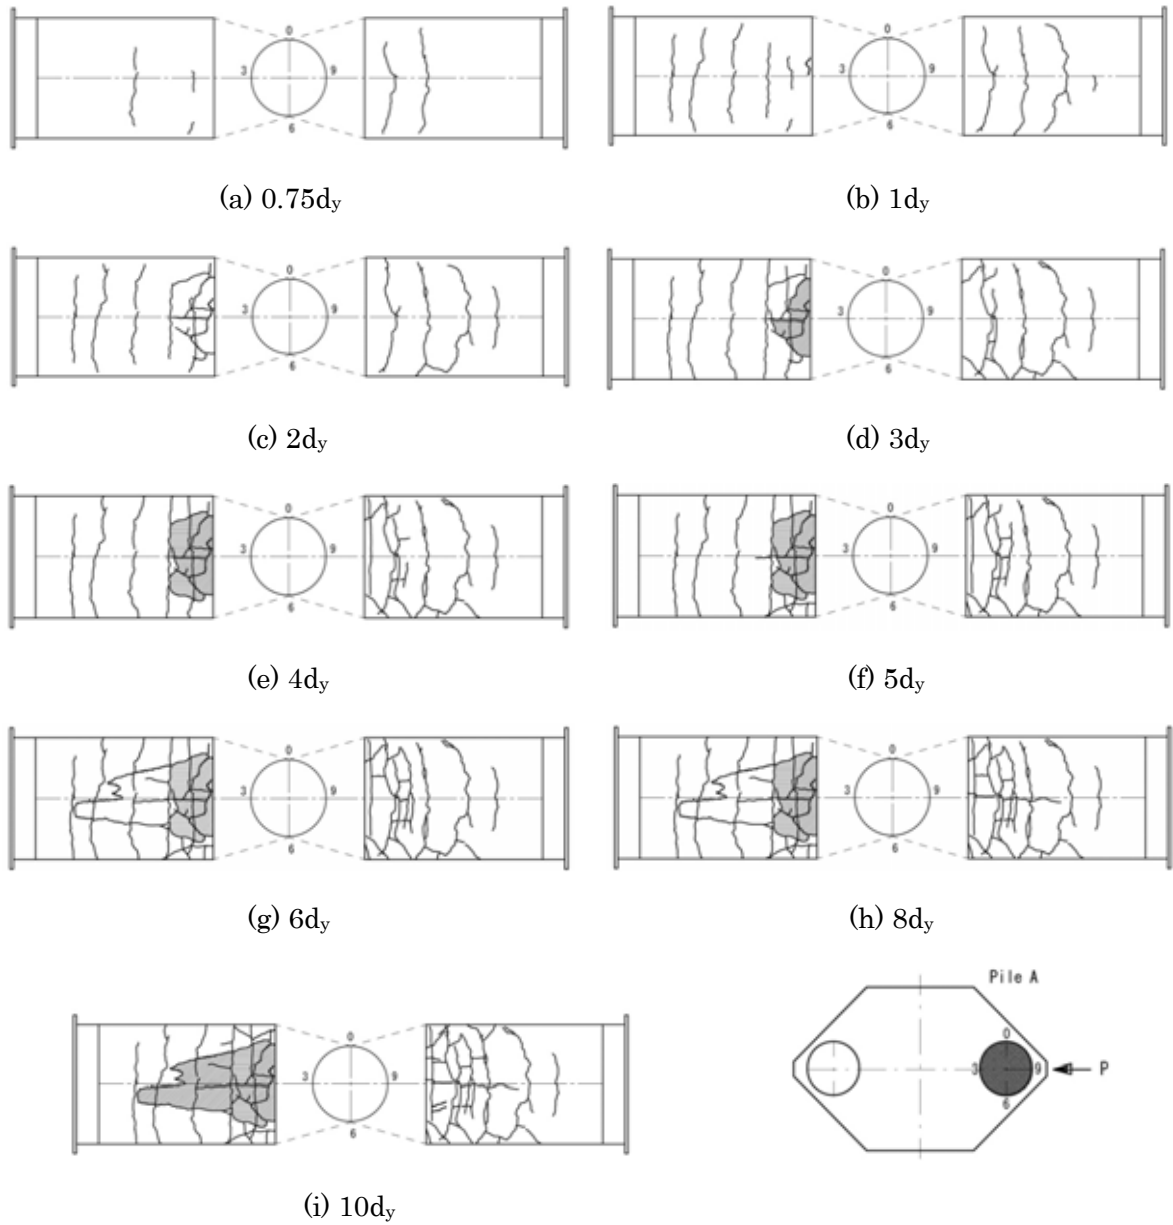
杭体のひび割れ進行状況図 (Case CPP-C-1, PileA)
